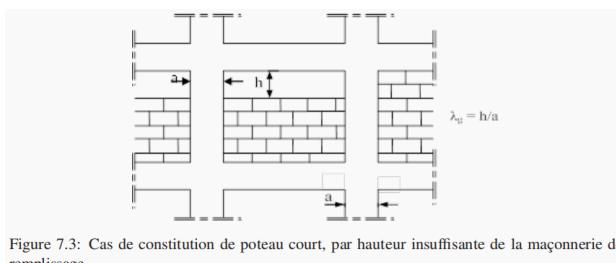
Cas de constitution de poteau court, par hauteur insuffisante de la maçonnerie de remplissage
